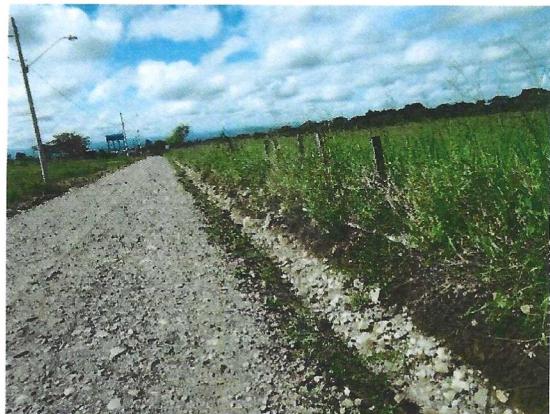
Vista general. Tramo prospectado. Alterado por construcción de camino interno.
